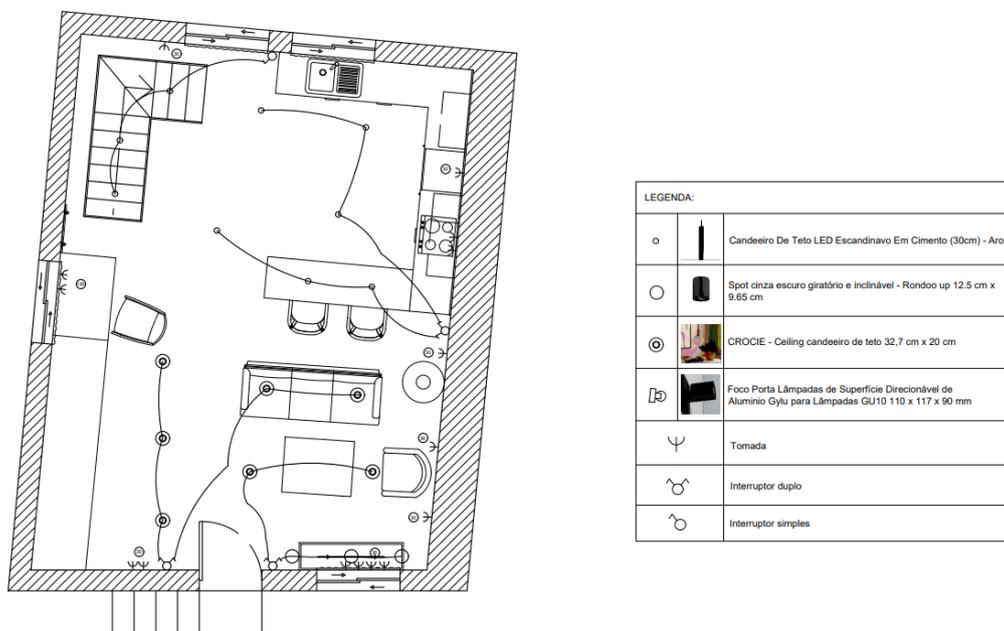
Planta de iluminação e tomadas piso 0. Fonte: Maria Leonor.
